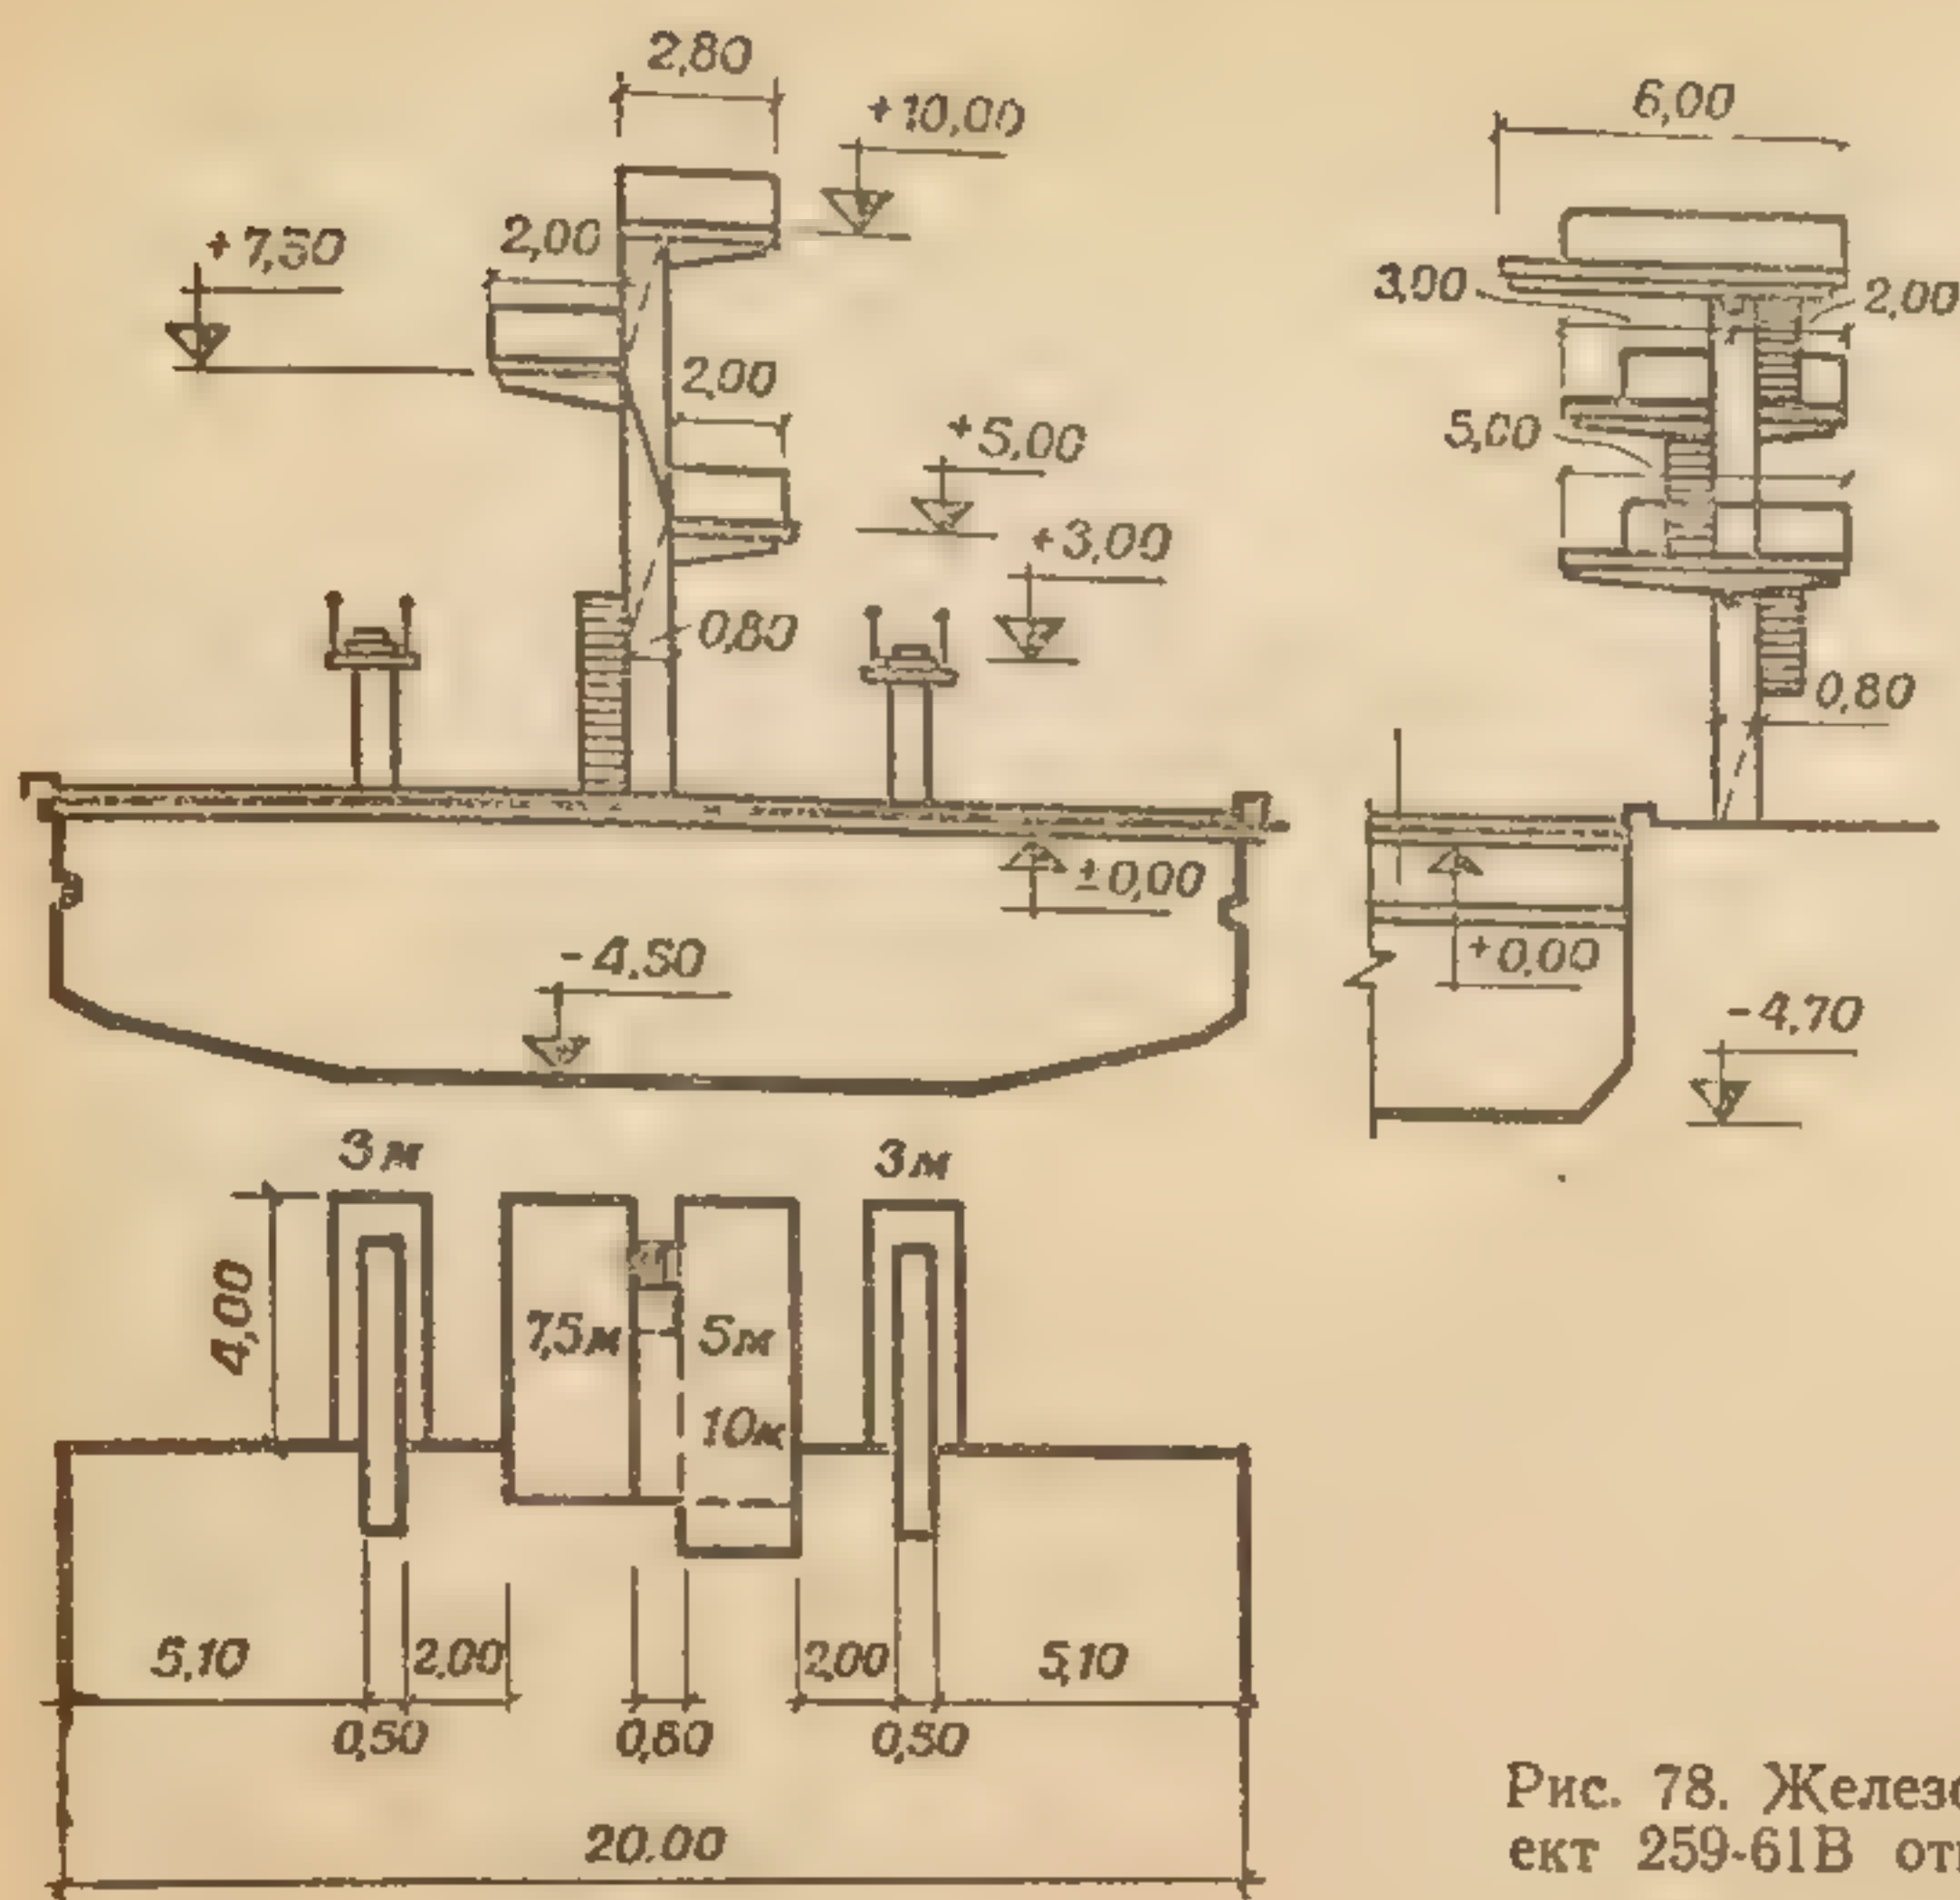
Железобетонные вышки (типовой проект 259-61В открытого искусственного бассейна для плавания)
